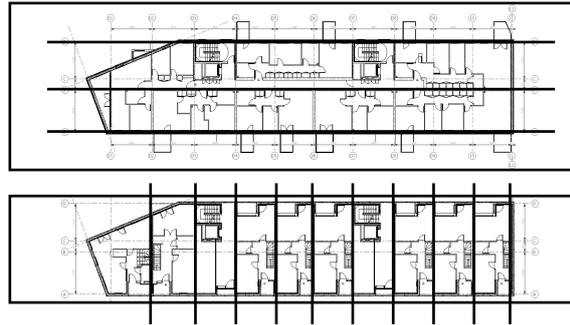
8-geschossiges Mehrfamilienhaus Bridport Place in London.
